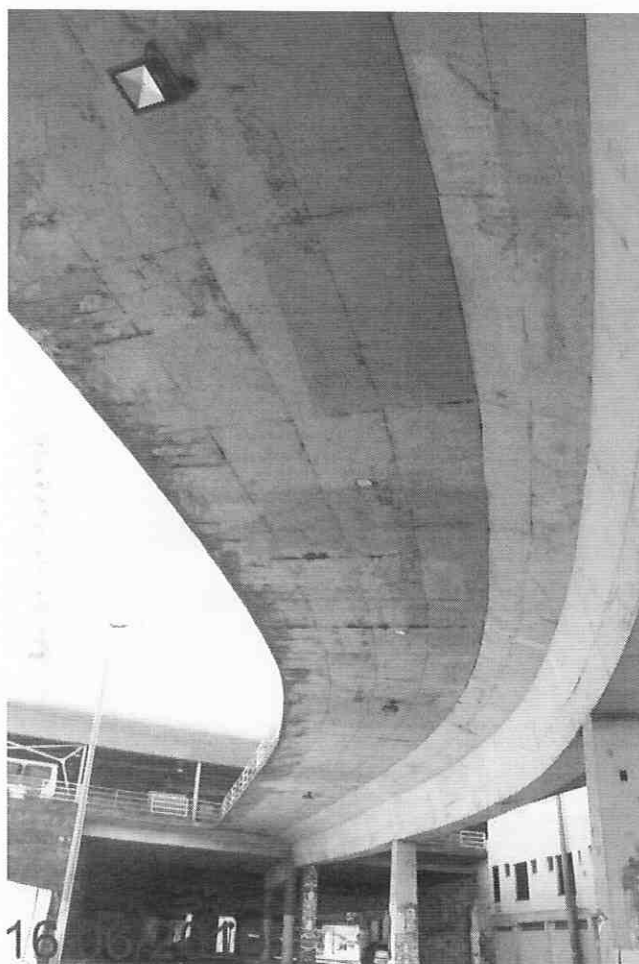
Vista frontal inferior da Passarela, detalhe de ausência de pingadeira laterais, processo de infiltração e armaduras expostas
